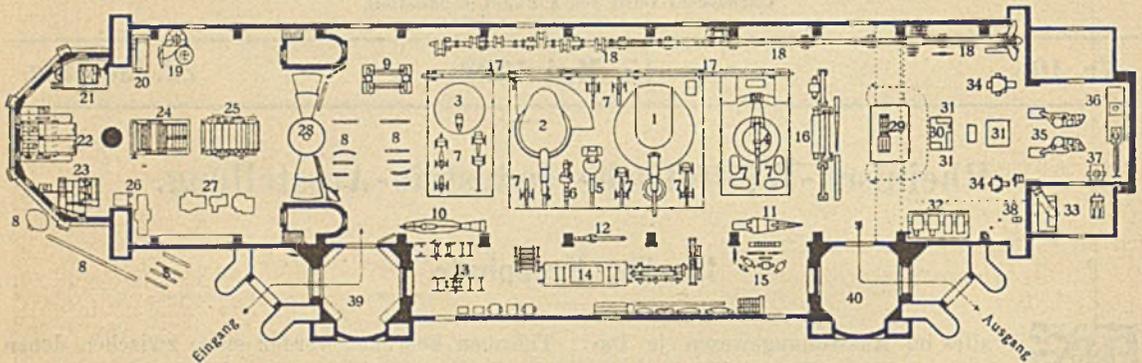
Lageplan der Ausstellungsgegenstände in der Krupp-Halle.
